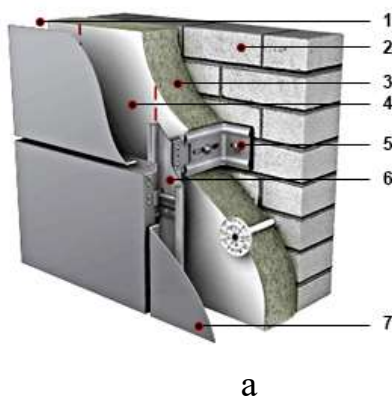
Утеплення стін за методом "вентильованого фасаду" [32]
